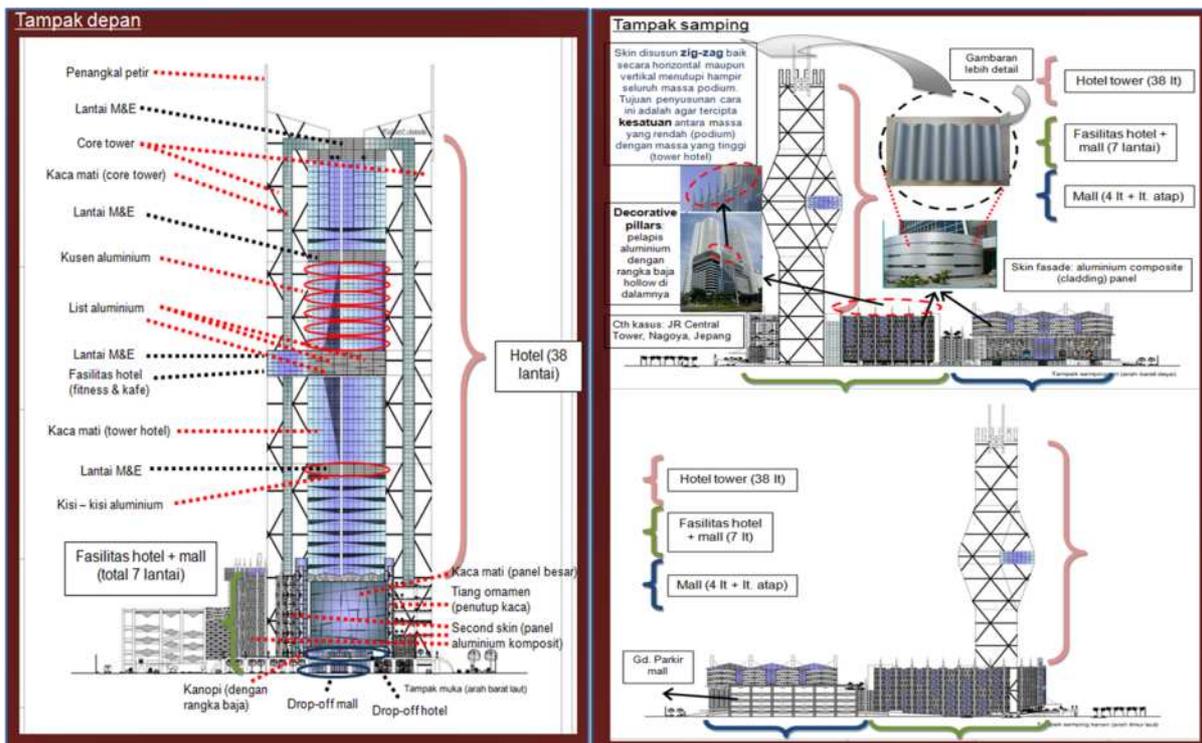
Konsep Zoning Vertikal Potongan A-A
